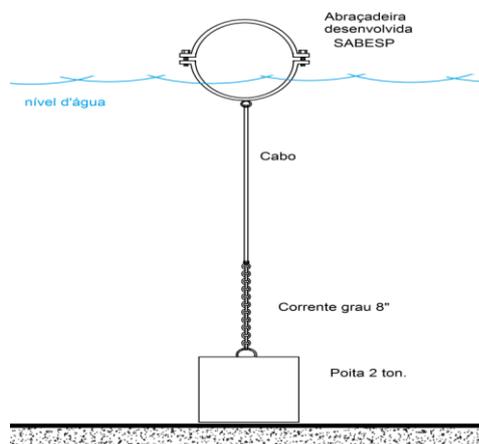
Projeto do sistema de apoitamento fluvial da barreira flutuante com fixação de abraçadeiras.
